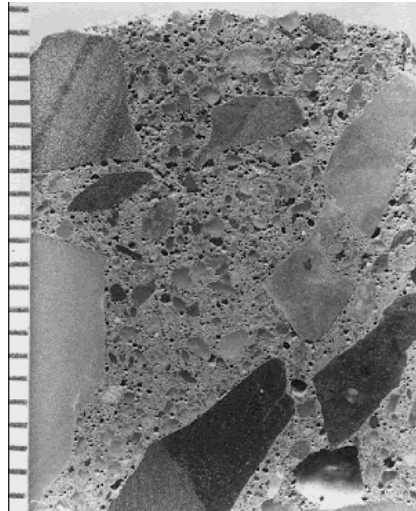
SECCIÓN TRANSVERSAL DEL CONCRETO [2]
